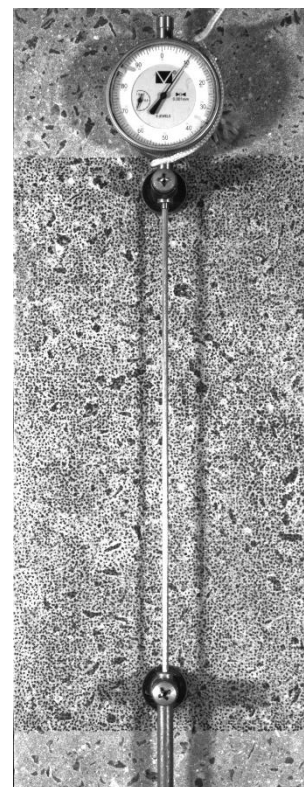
Візерунок з крапок на досліджуваній бетонній поверхні
